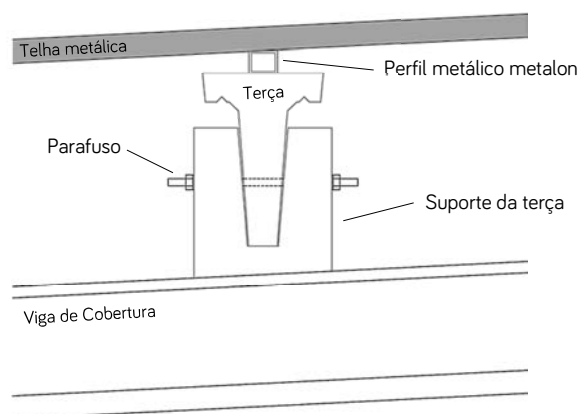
Esquema da ligação das terças às vigas de cobertura. Fonte: Elaborado pelo Autor
